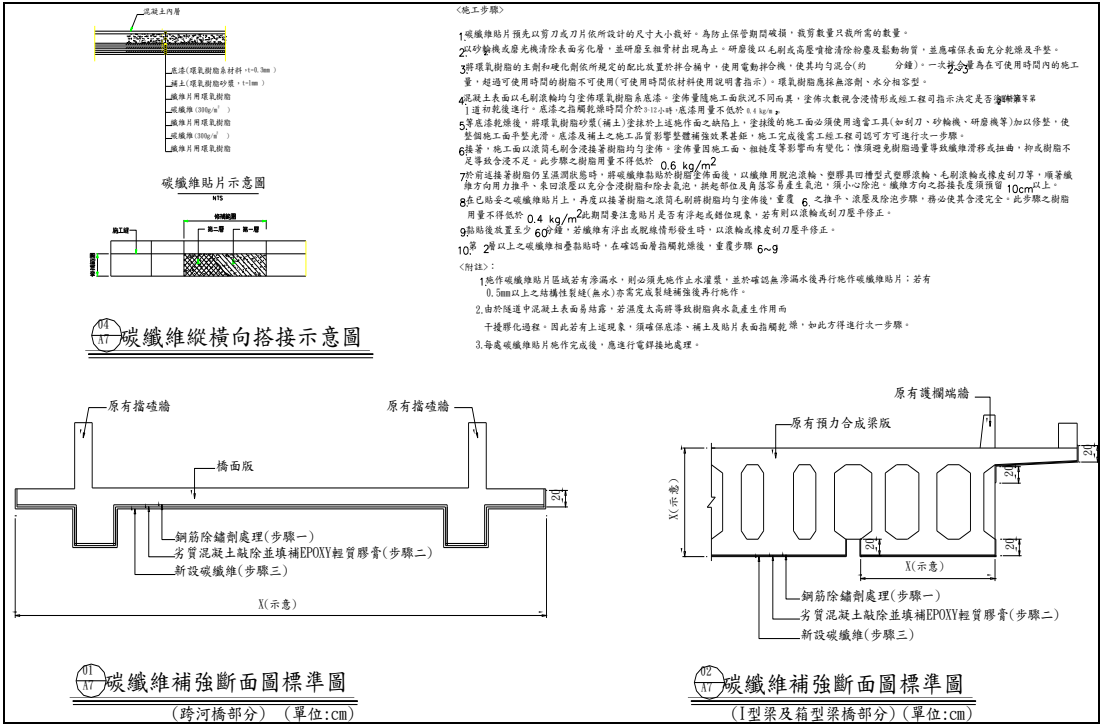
橋梁工程混凝土裂縫碳纖維圍束耐震補強示意圖
